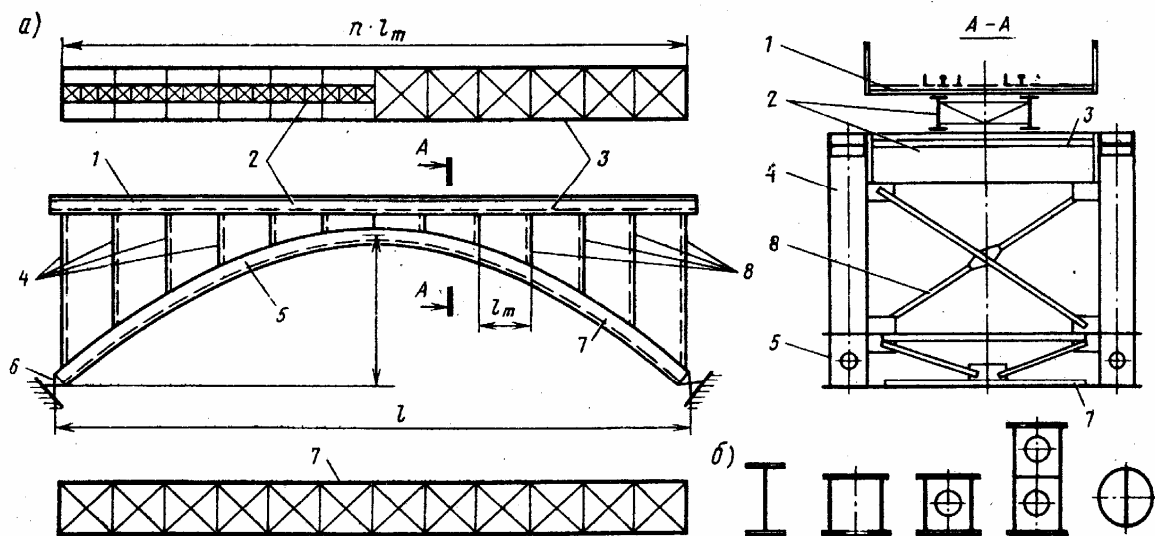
Конструкция арочного пролетного строения и формы сечений арок
